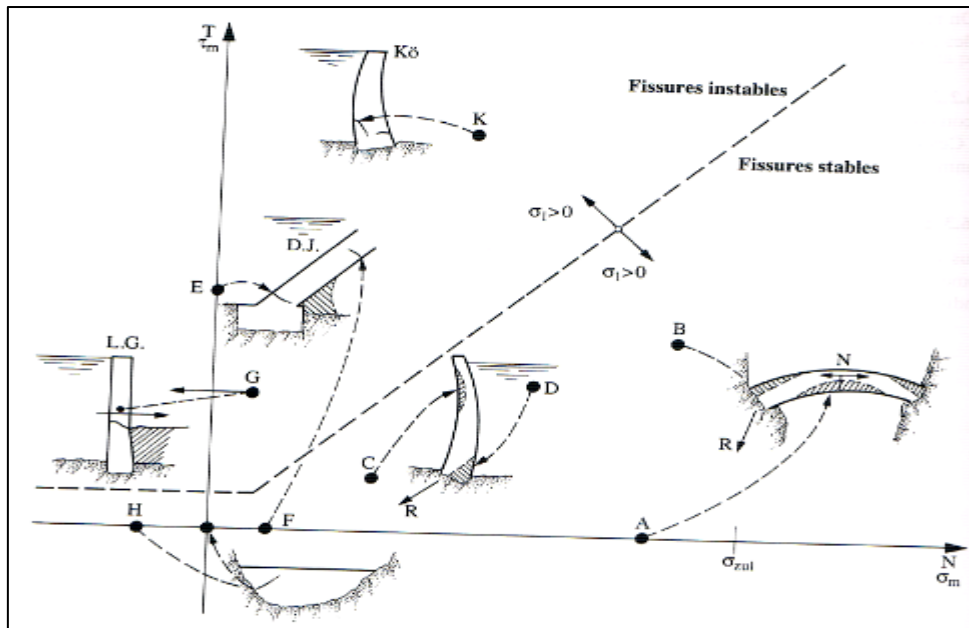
Fissures stables et instables dans un barrage voûte (A.J.Scheleiss et H.Pougatsch,2011).
